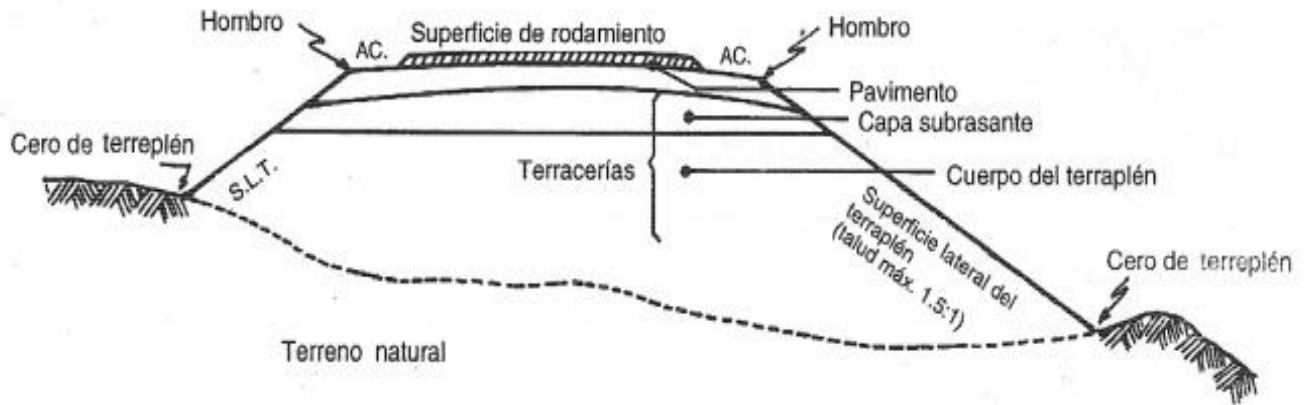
Sección transversal típica en terraplén para carreteras de dos carriles.
